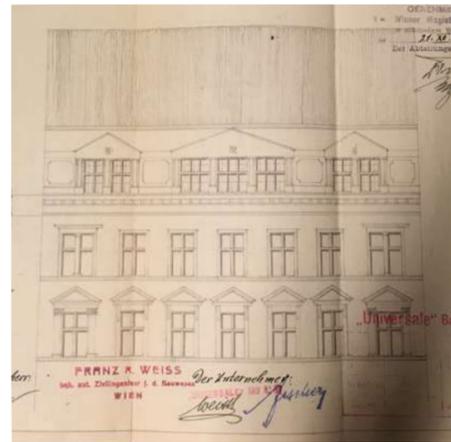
Schwindgasse 9 – Grundrisse Auswechslungsplan 1874, Fassade und Schnitt 1921, Lageplan 1922
